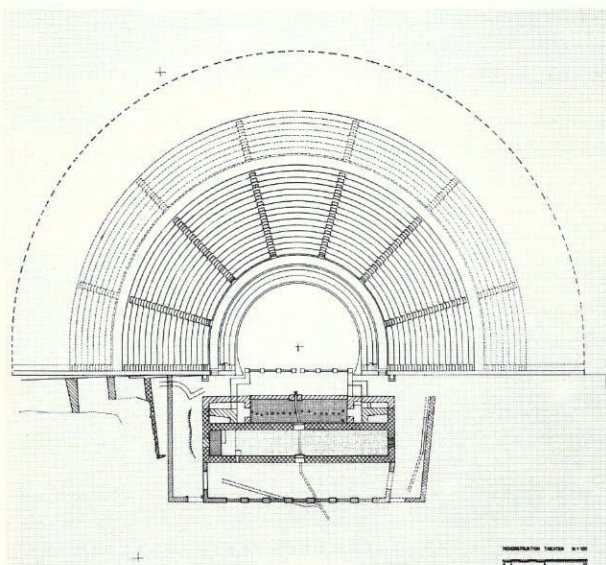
Pianta schematica del teatro 1988. L'angolo sud-est del complesso scenico è ipotetico.
